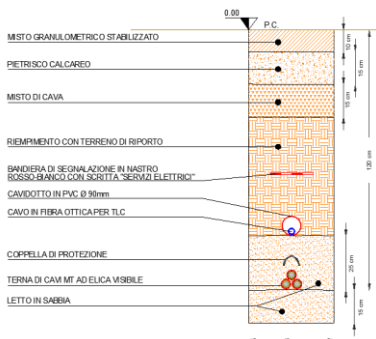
Sezione tipo di scavo per la posa del cavidotto su strada esistente. I cavi elettrici, rispetto ai piani finiti di strade o piazzali o alla quota del piano di campagna, saranno posati negli scavi alla profondità di circa 1,00-1,20m.
